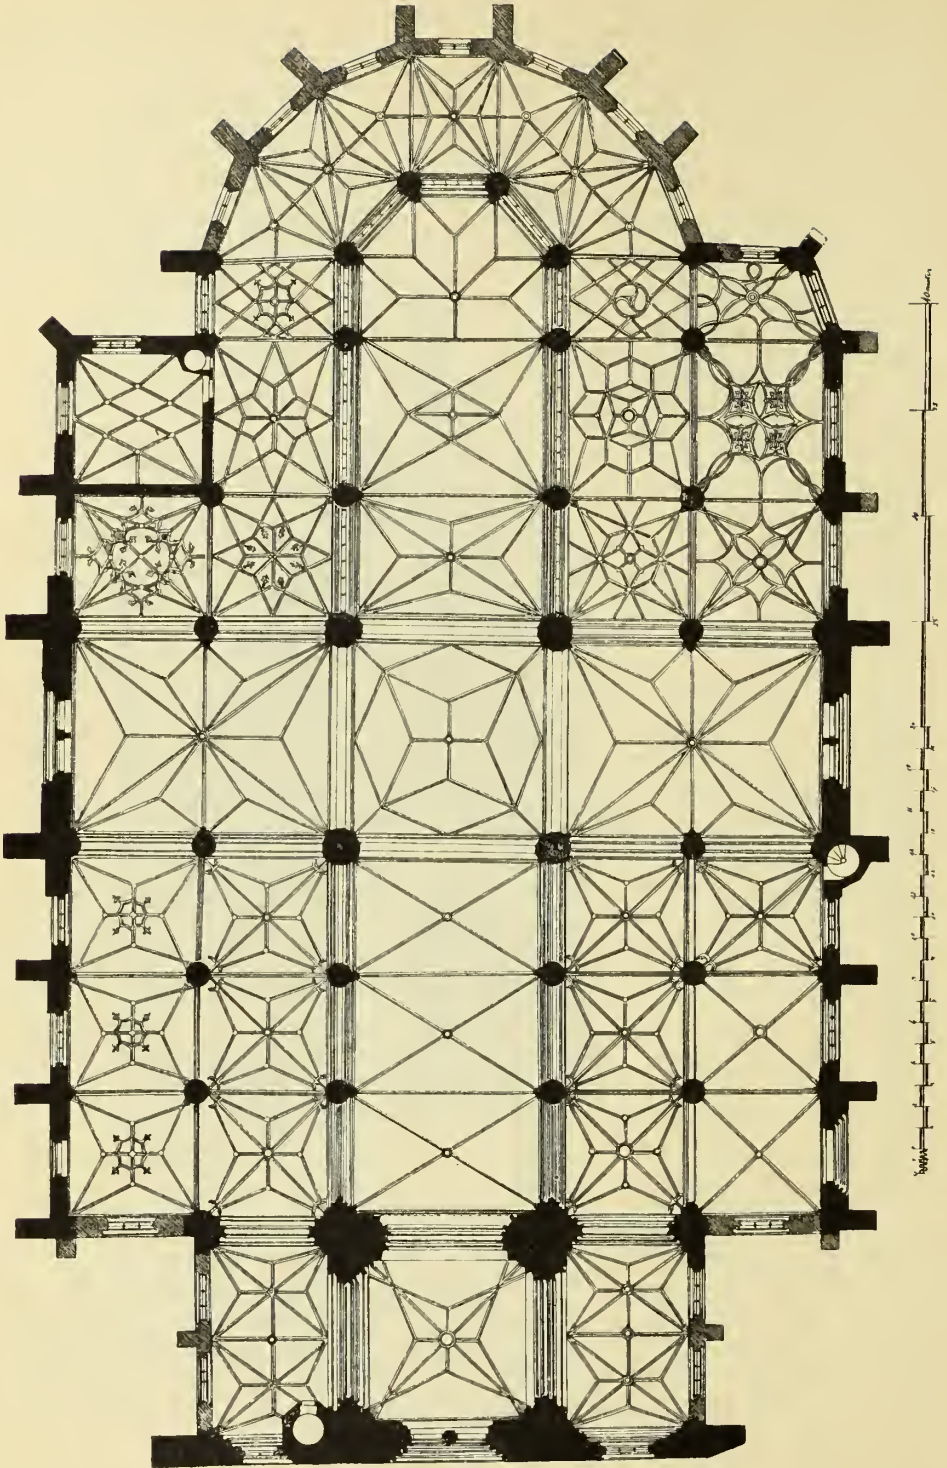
Wesel. Grundriss der Willibrordikirche.
